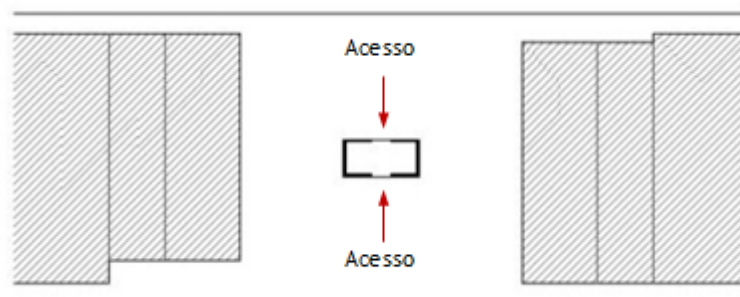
Implantação da torre e planta do rés-do-chão.
